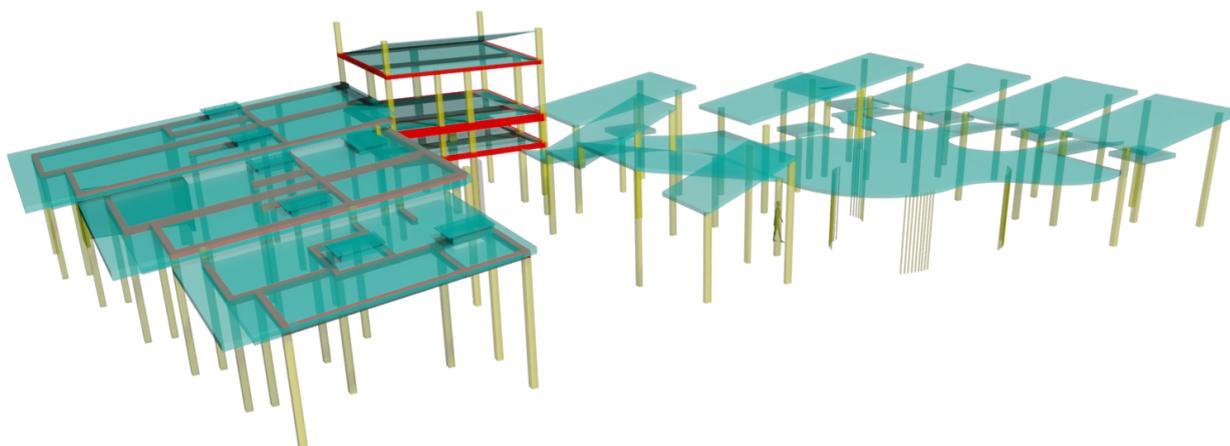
Esquema estrutural das duas estruturas de cobertura da edificação
